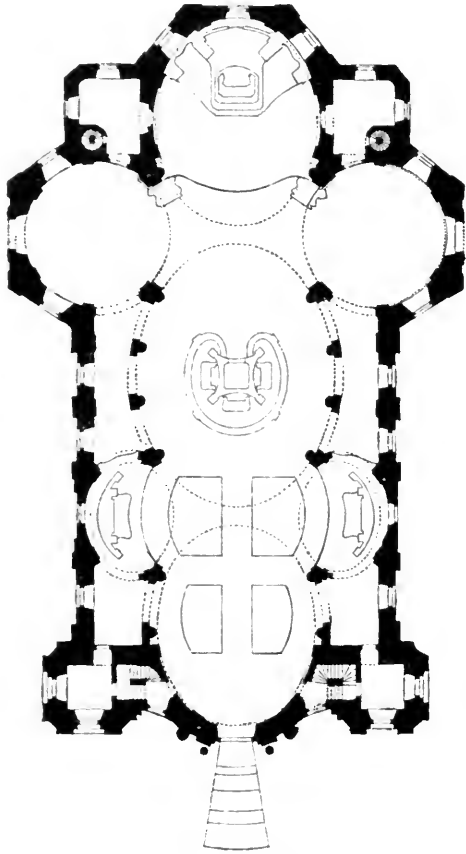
Grundriß der Wallfahrtskirche Vierzehnheiligen.
